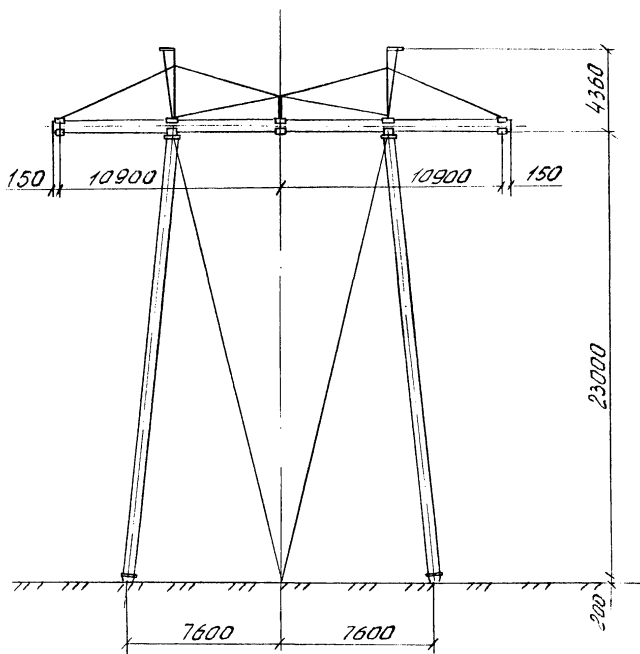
Промежуточная железобетонная опора типа ПБ 500-1
